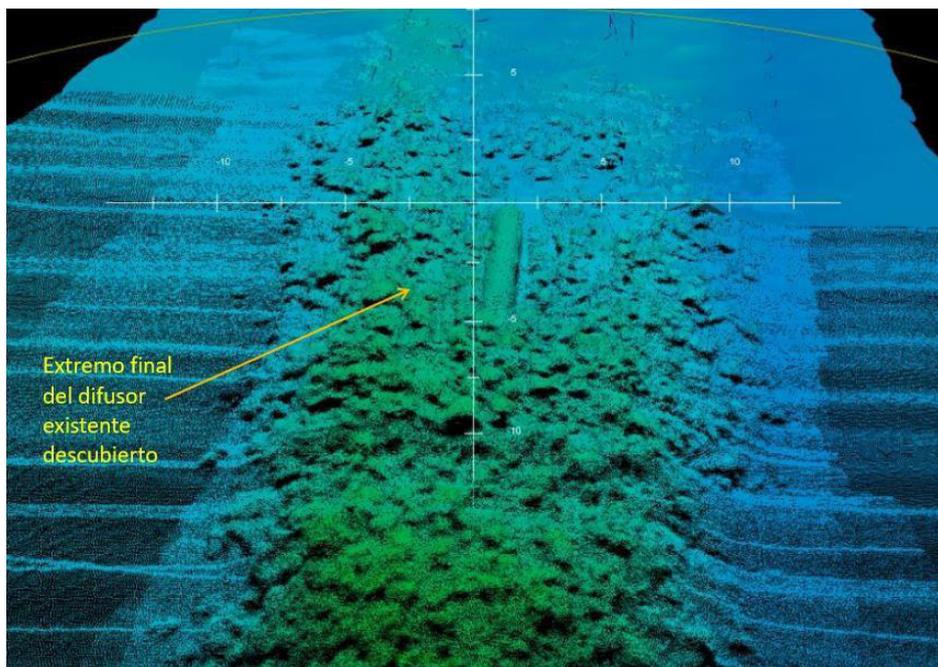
Extremo final de la conducción existente. (Batimetría 2016). Vista desde “tierra” hacia “mar”.
